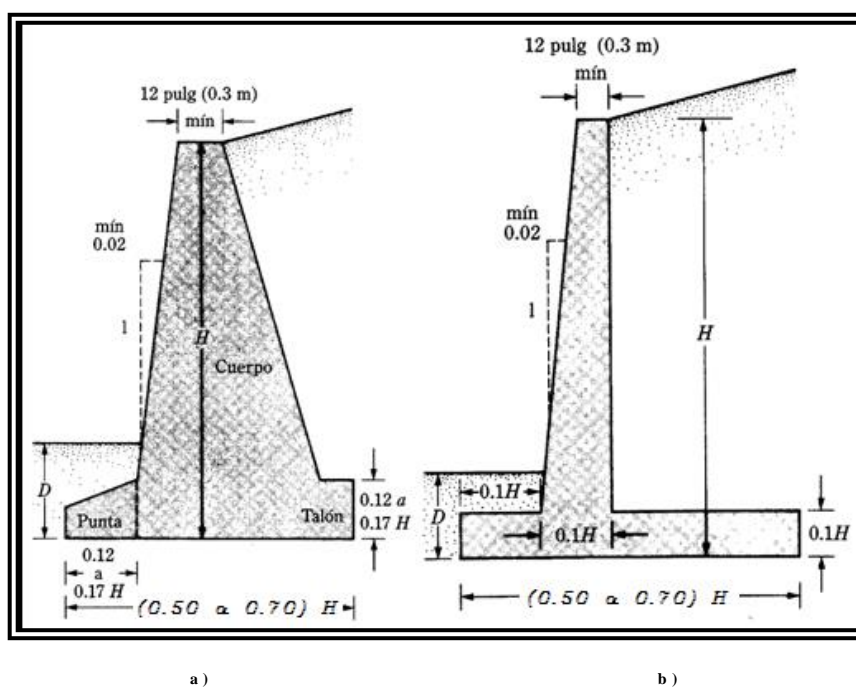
Dimensiones aproximadas para varios componentes de muros de retención para revisiones iniciales de estabilidad: a) Muros de mampostería y b) Muros de concreto.²⁶¹
